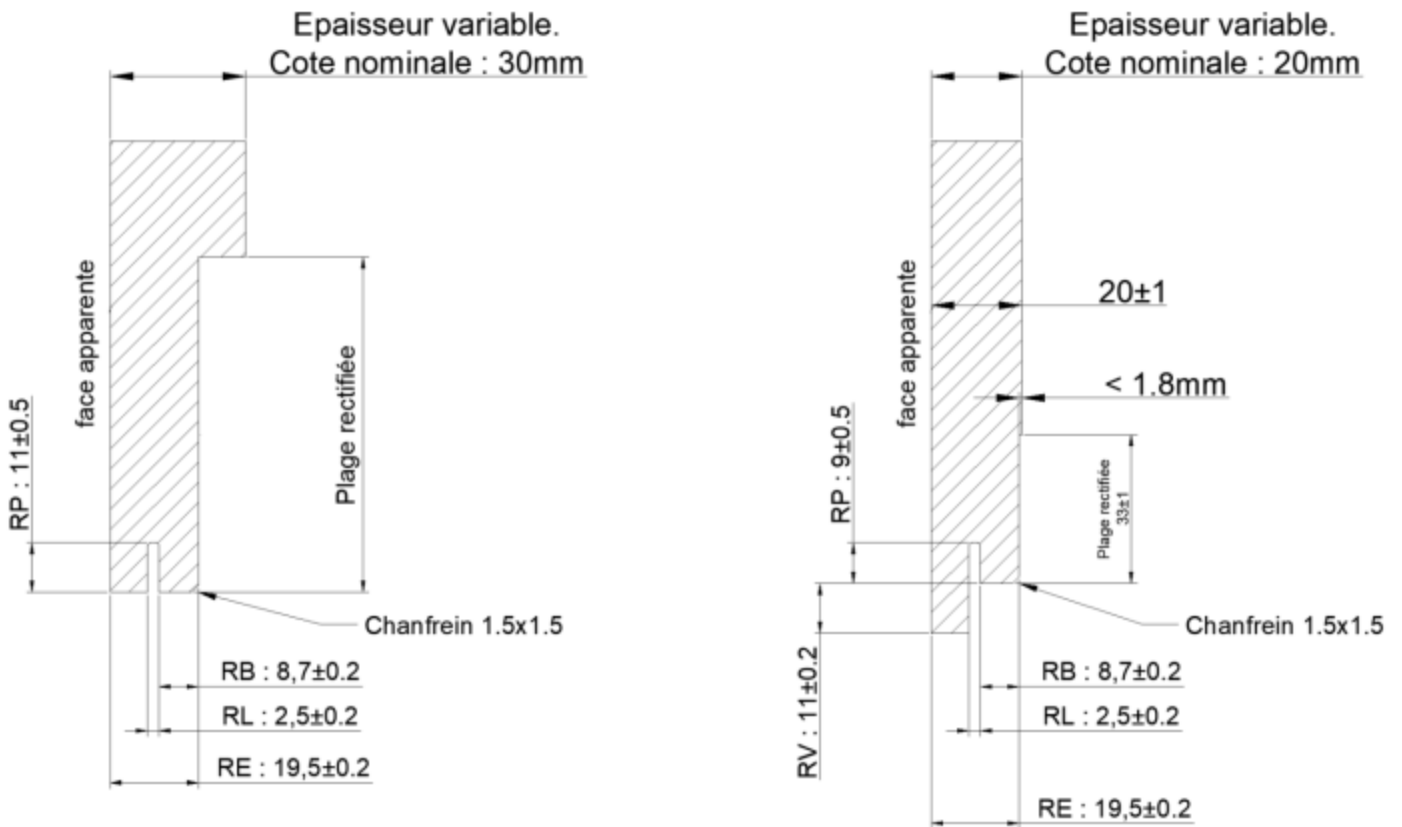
Rainure Type E continuïté pierre 2 et 3 cm / Rainure type Chabillage de linteau sur rail RT
